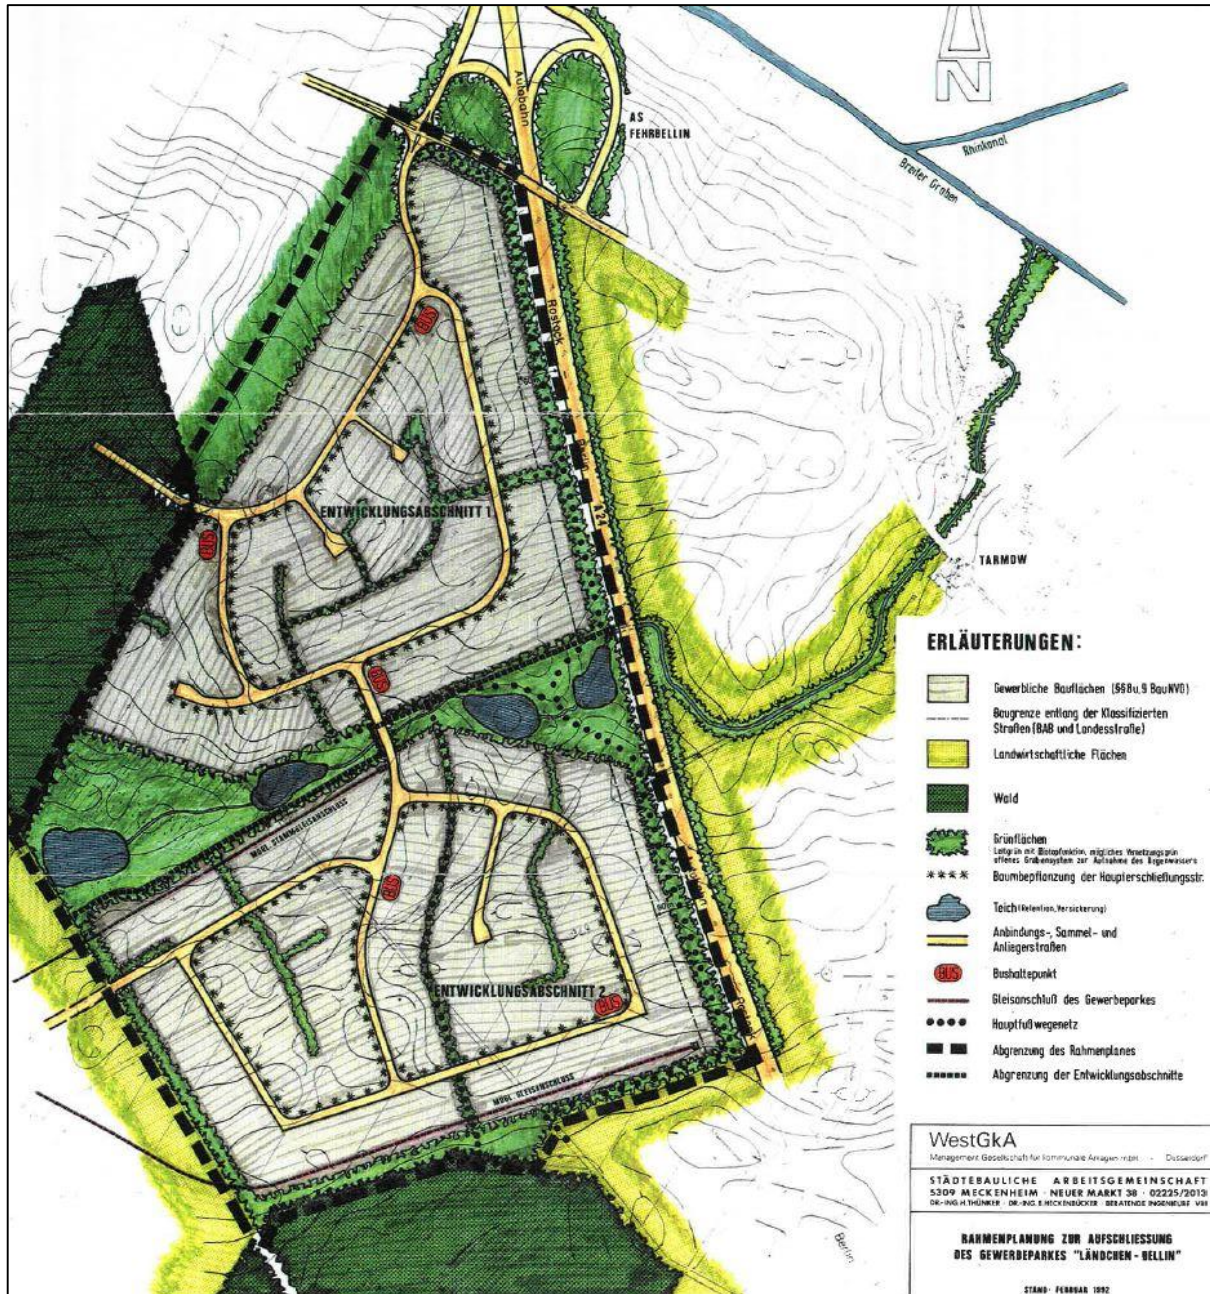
Rahmenplan Gewerbepark „Ländchen-Bellin“ (1992)
